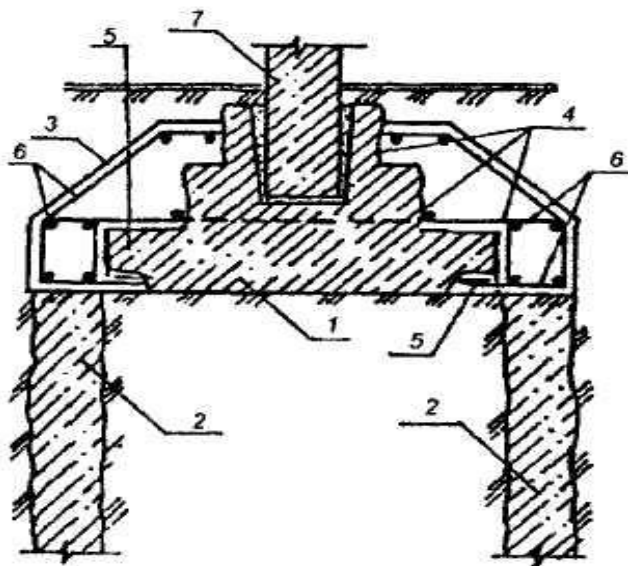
Передача нагрузки от фундамента на буронабивные сваи
